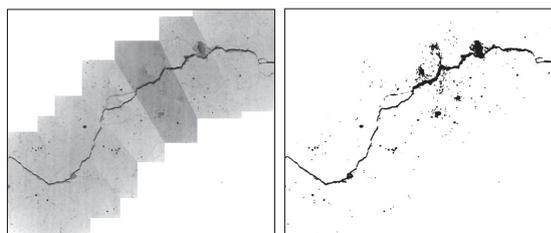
フリーソフト ImageJ を使ったひび割れ抽出例
